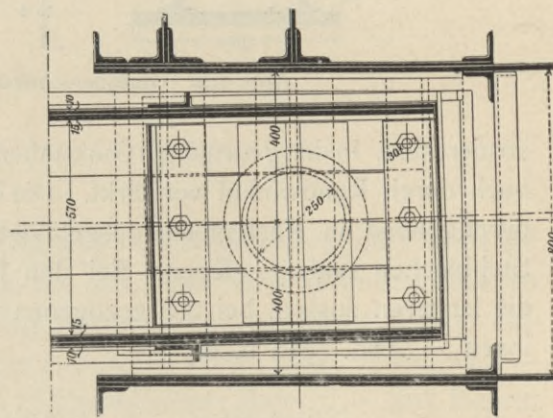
Horizontalschnitt G H. 1 : 20.
